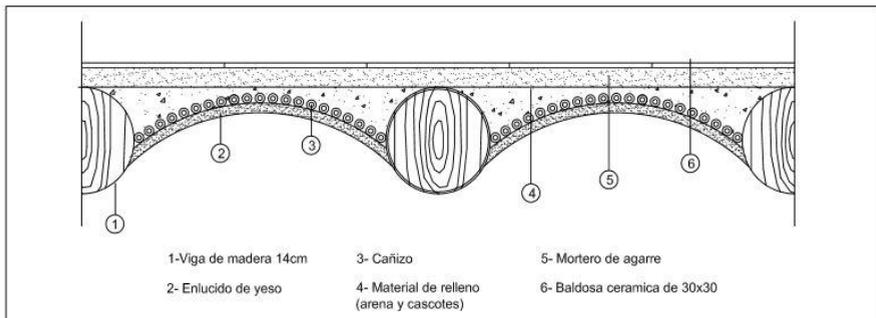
Detalle forjado planta segunda. 2014. Propia.
